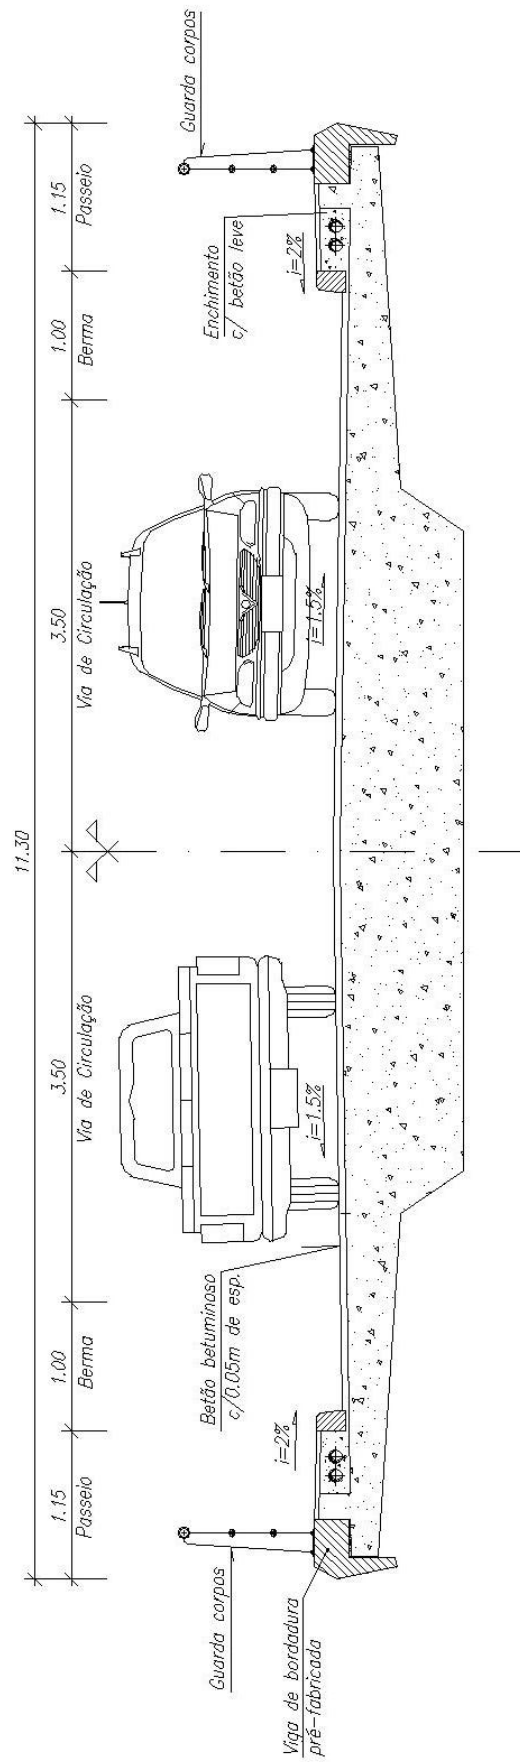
Seção transversal e perfil da via do tabuleiro em laje nervurada
